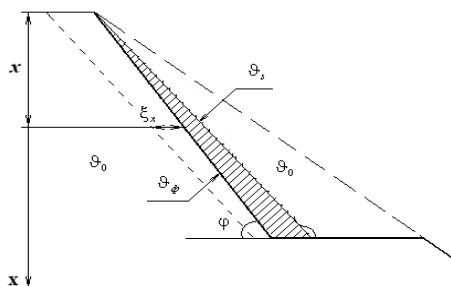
Схема к расчету отступления оттаивающего грунтового склона
